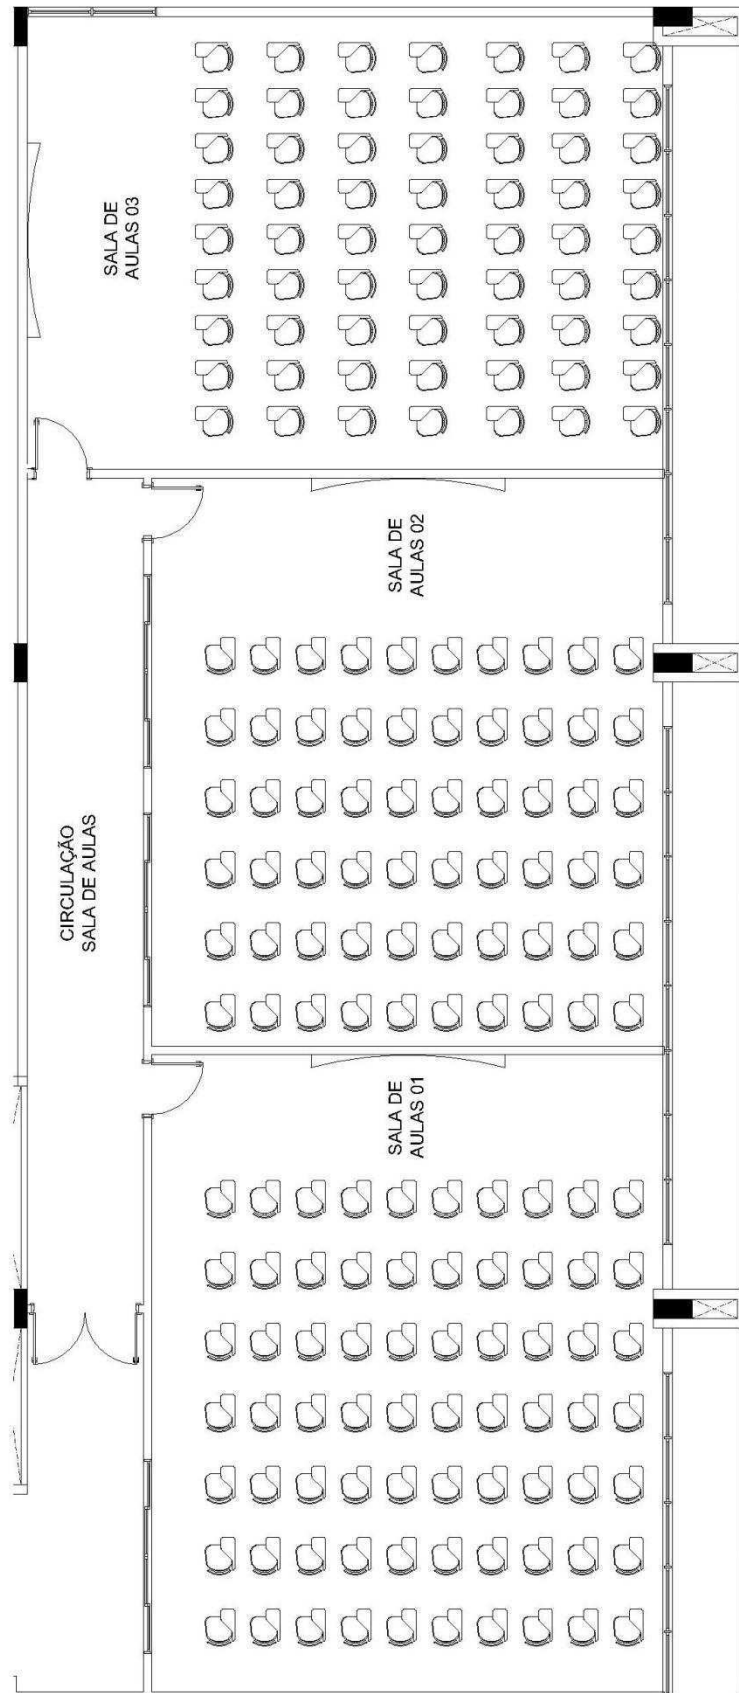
Planta baixa parcial do 2º Pavimento – Salas de aula
